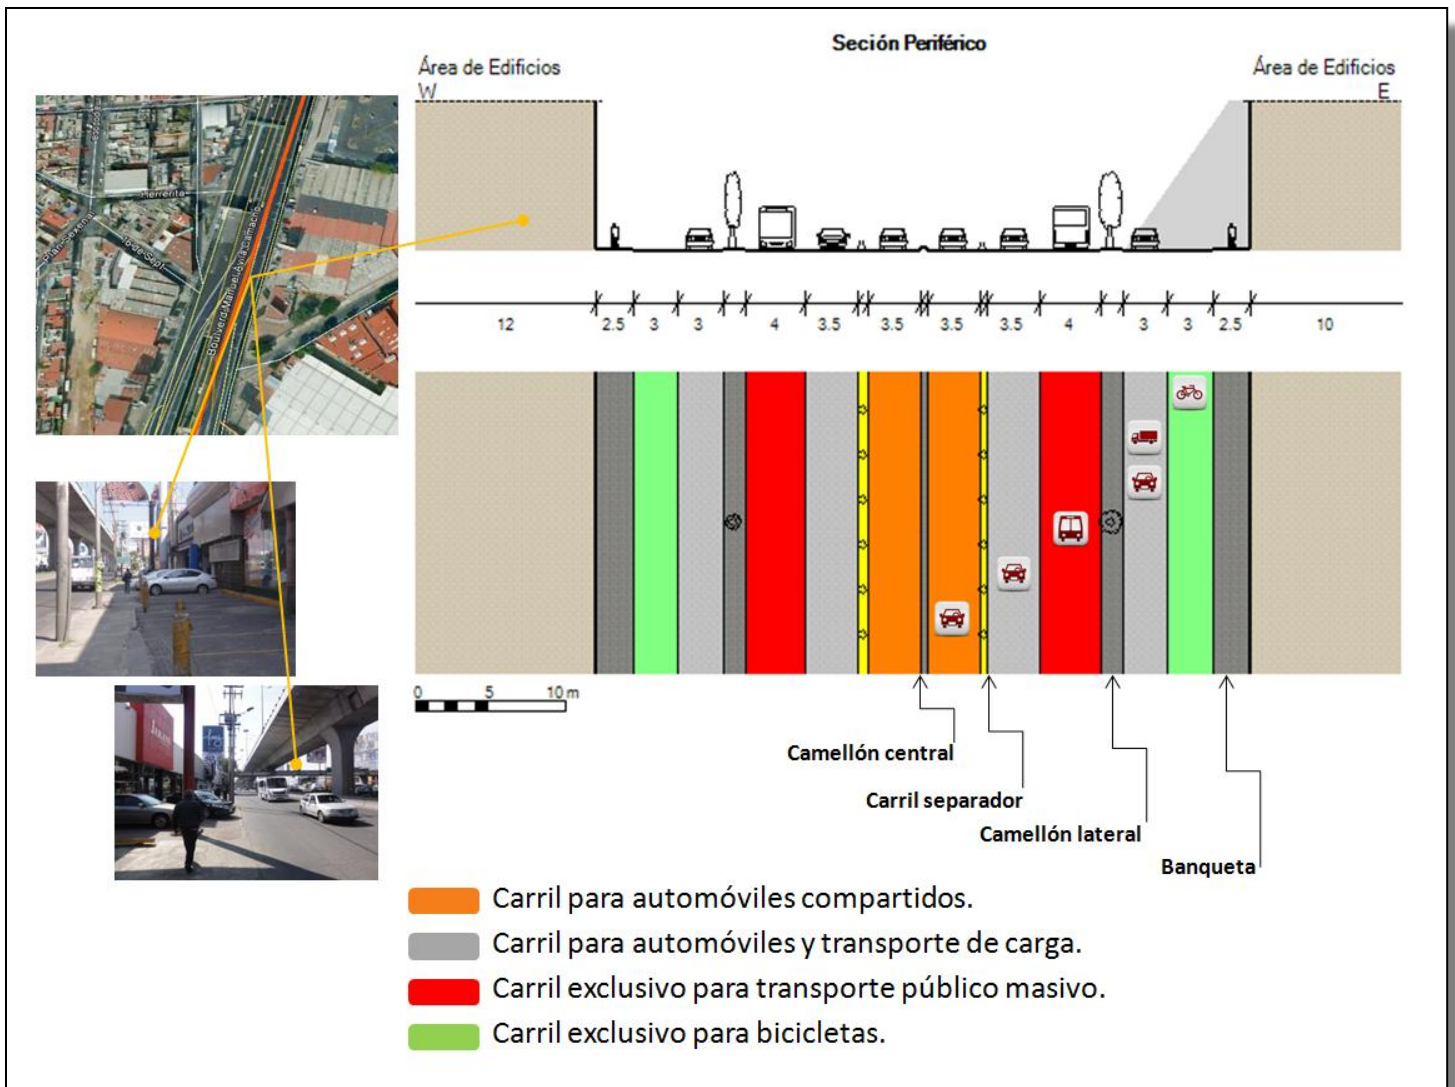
Sección tipo, localizada en el Periférico Boulevard Manuel Ávila Camacho y la Calle de Plásticos en la Colonia Alce Blanco, Naucalpan, Estado de México. Ancho de la sección: 43.60 m.; banquetas de 2.5 m. de ancho; camellones laterales: 1.5 m.; camellón central: 0.5 m.; a lo largo de 1 kilómetro de vía se proponen cuatro estaciones de bicicletas a cada 250 m.²⁶⁷
